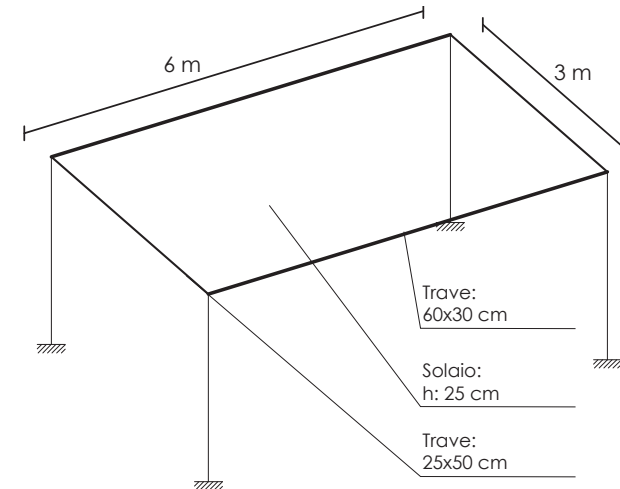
Schema strutturale; Fonte: elaborazione personale;
